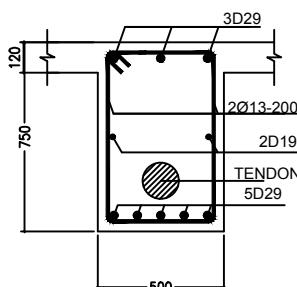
DETAIL PENULANGAN BALOK PRATEKAN (BP1)
